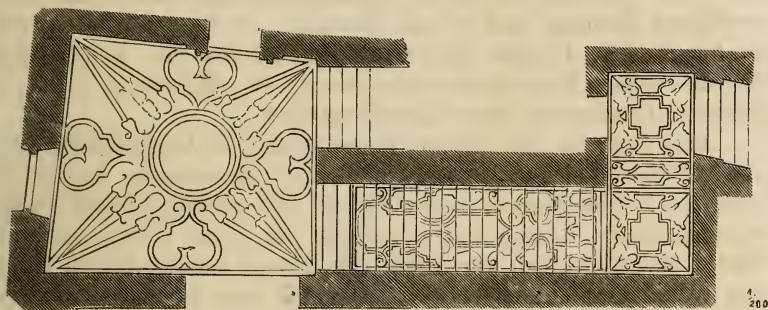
München. Residenz. Grundriss einer Treppe.
